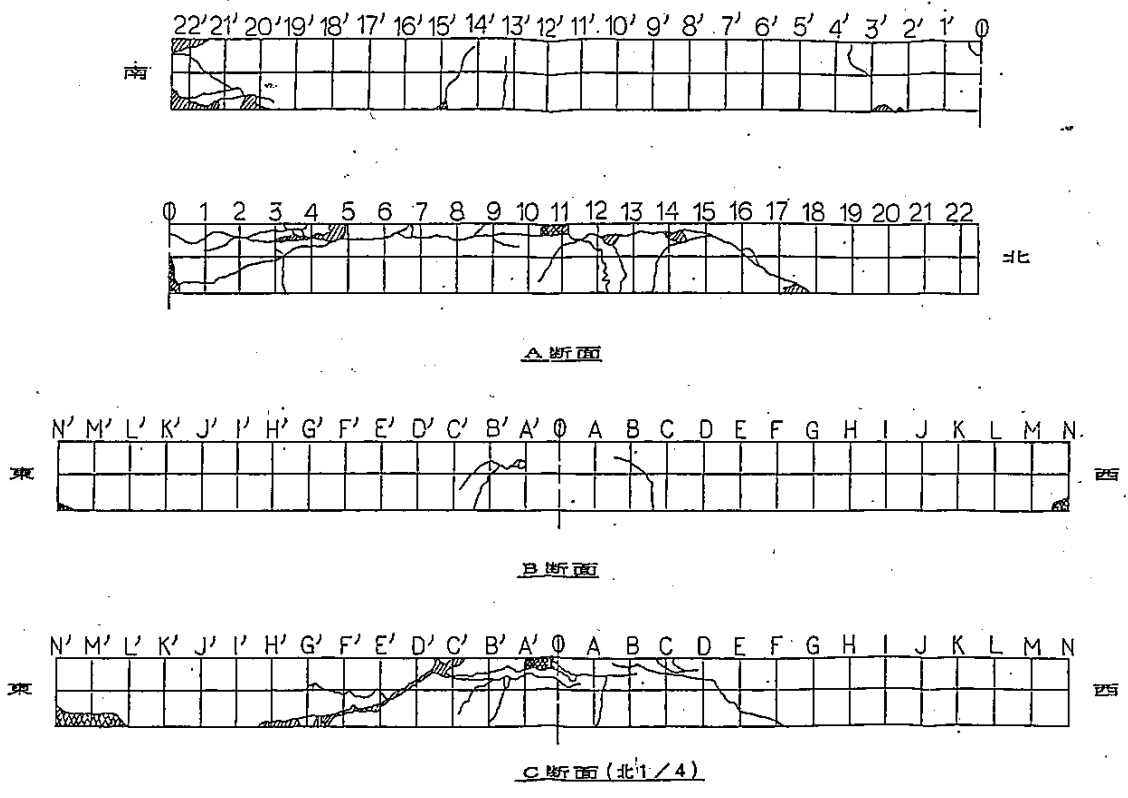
試験後のひび割れ状況 (床版断面)
